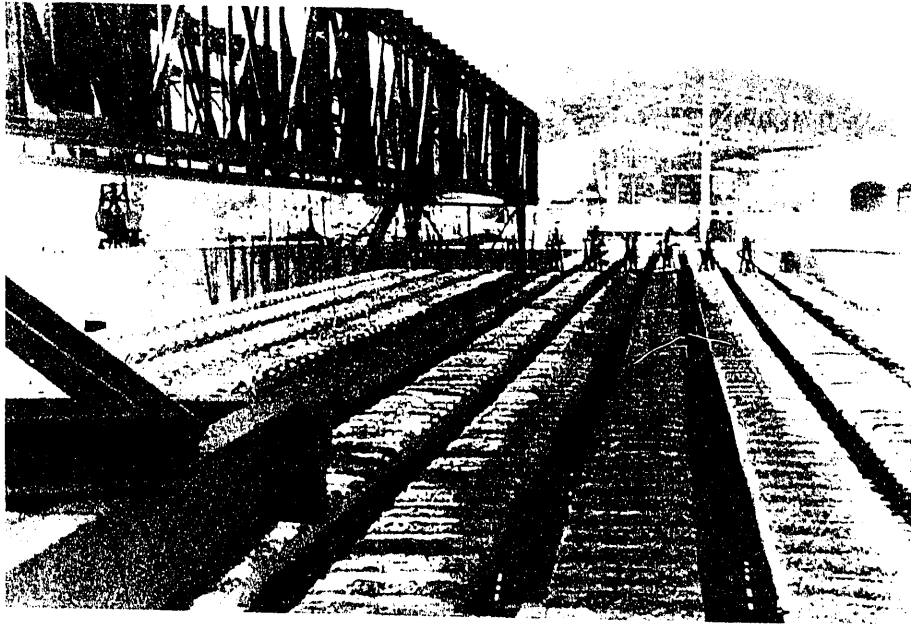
Aspecto parcial del puente de lanzamiento. En la foto aparecen colocadas 11 vigas del tramo de mayor luz y faltan por colocar 5 vigas más.
